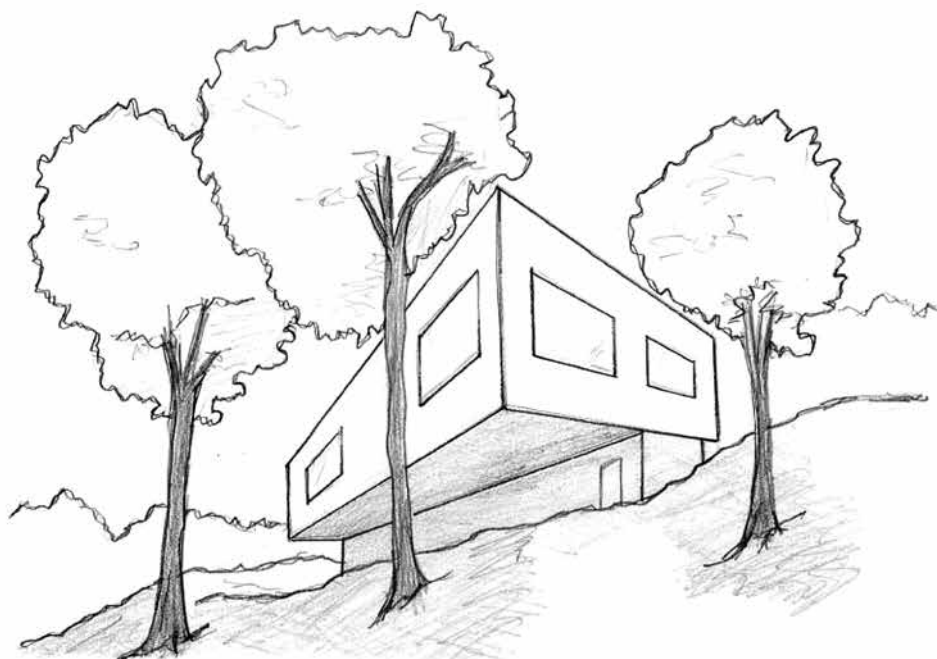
Esquema de um cantilever que possibilita a convivência da edificação com as árvores próximas.
